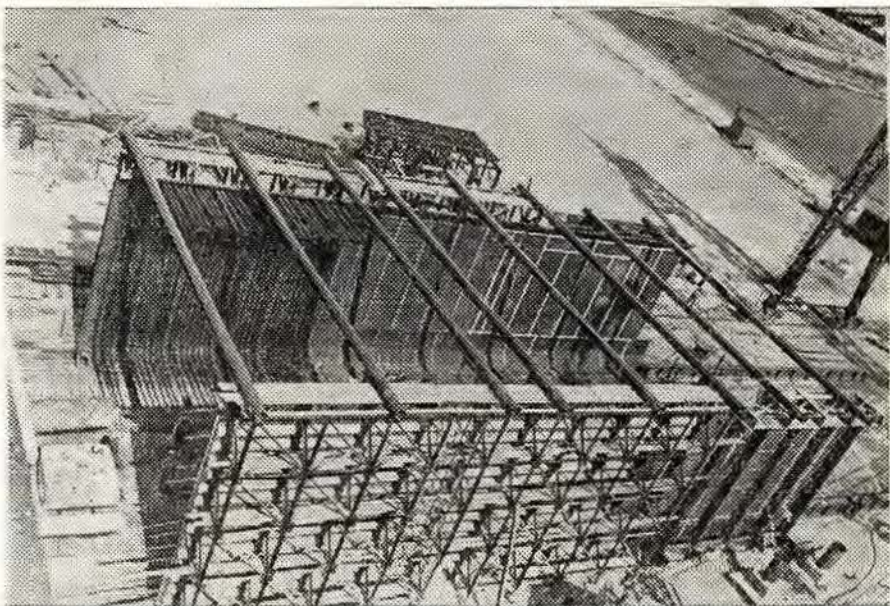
Монтаж металлонзоляции и внутренней инвентарной опалубки тоннельной секции.
